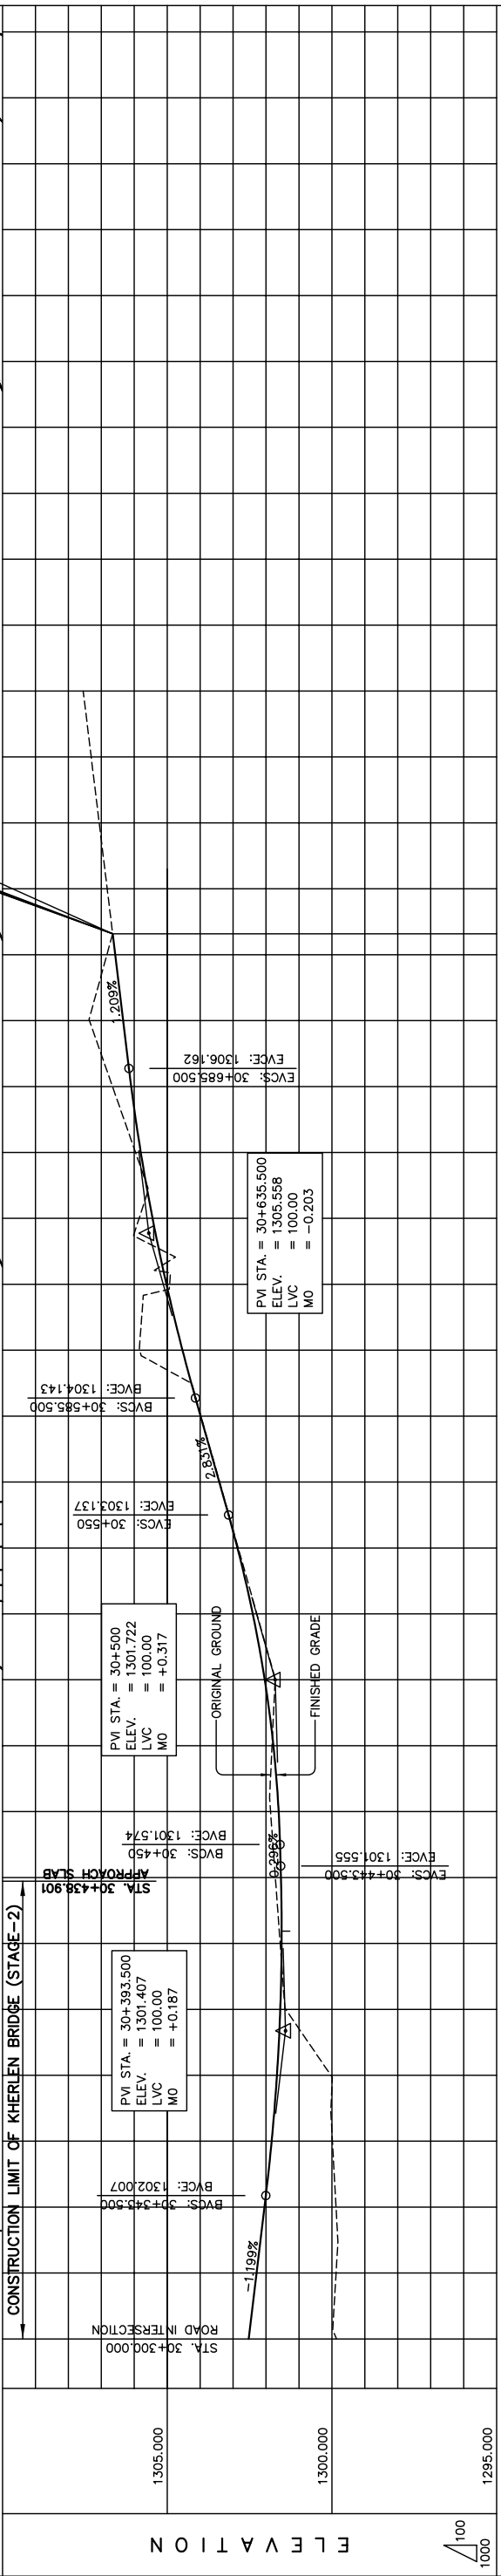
全体平面・縦断面 (Section II 新設区間 Sta.29+600-Sta.30+300)
